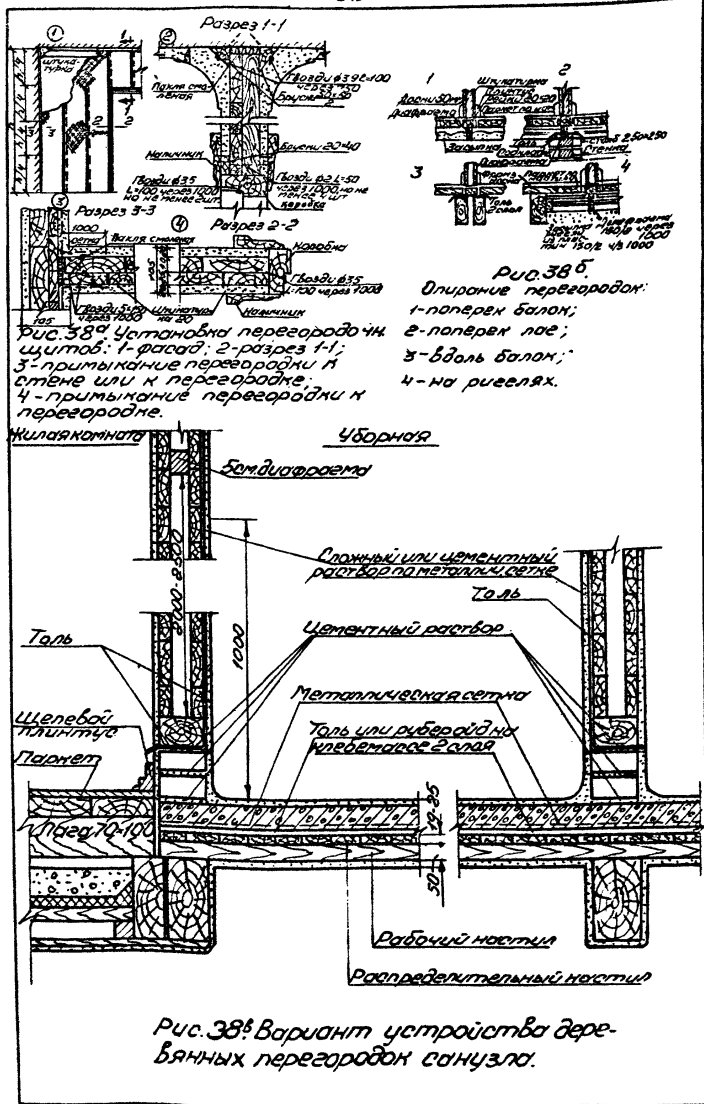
^б Вариант устройства деревянных перегородок санузла.
